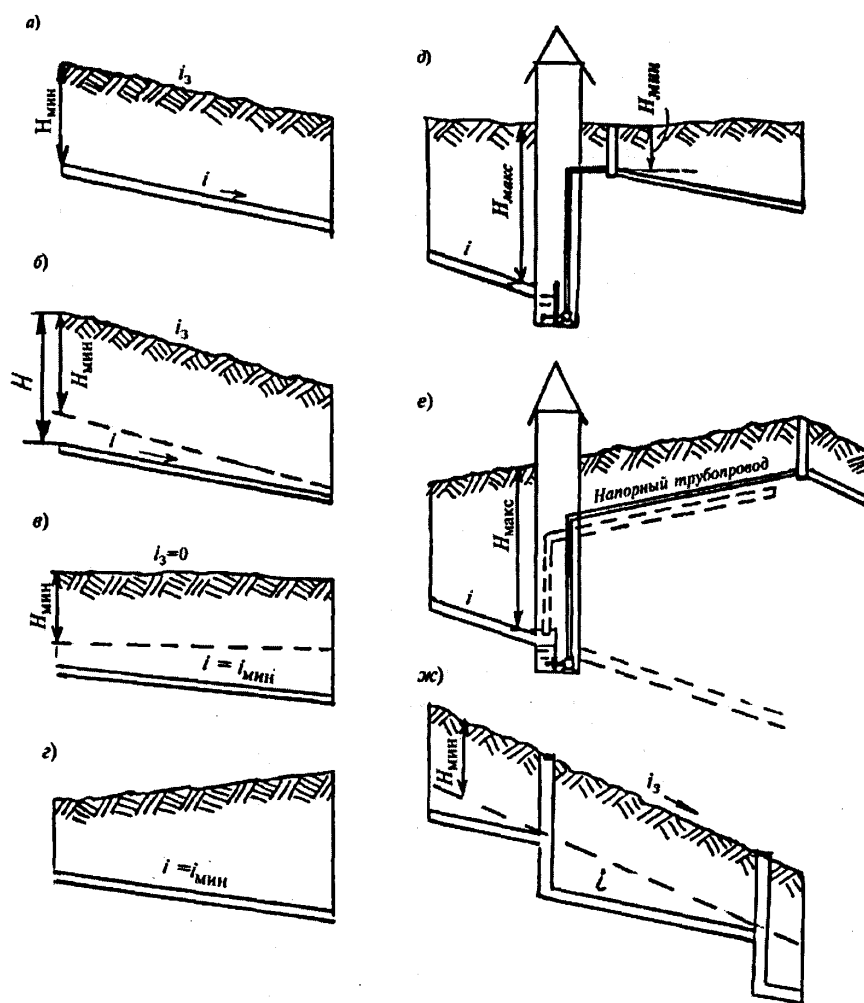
Рекомендации по выбору уклона укладки труб
